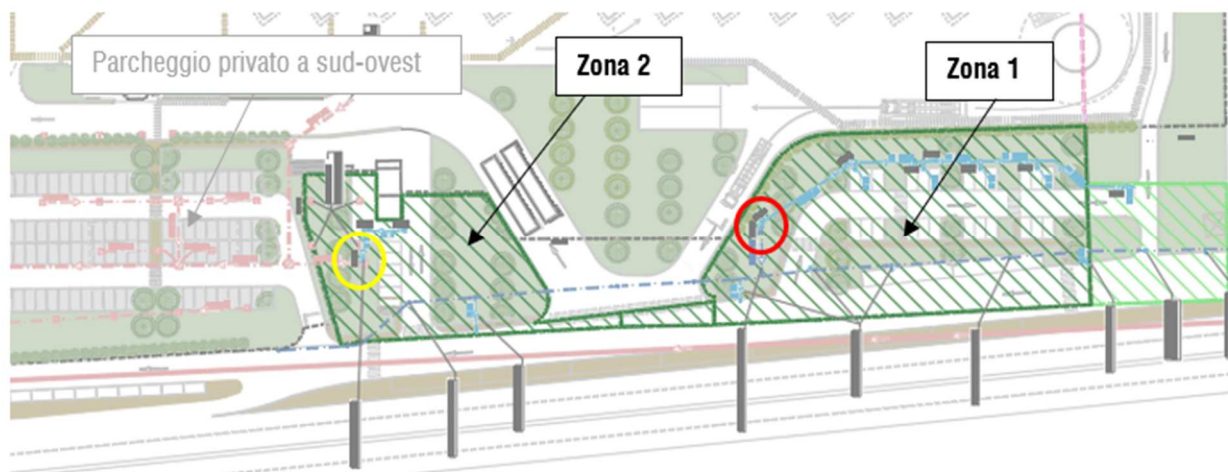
Individuazione delle zone in cessione oggetto di intervento
